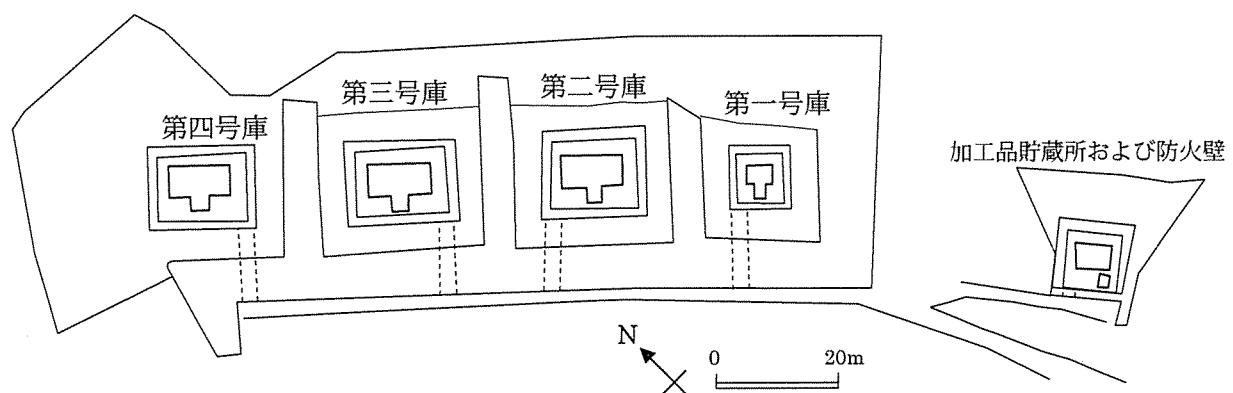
宇都野火薬庫および加工品貯蔵所 平面図
